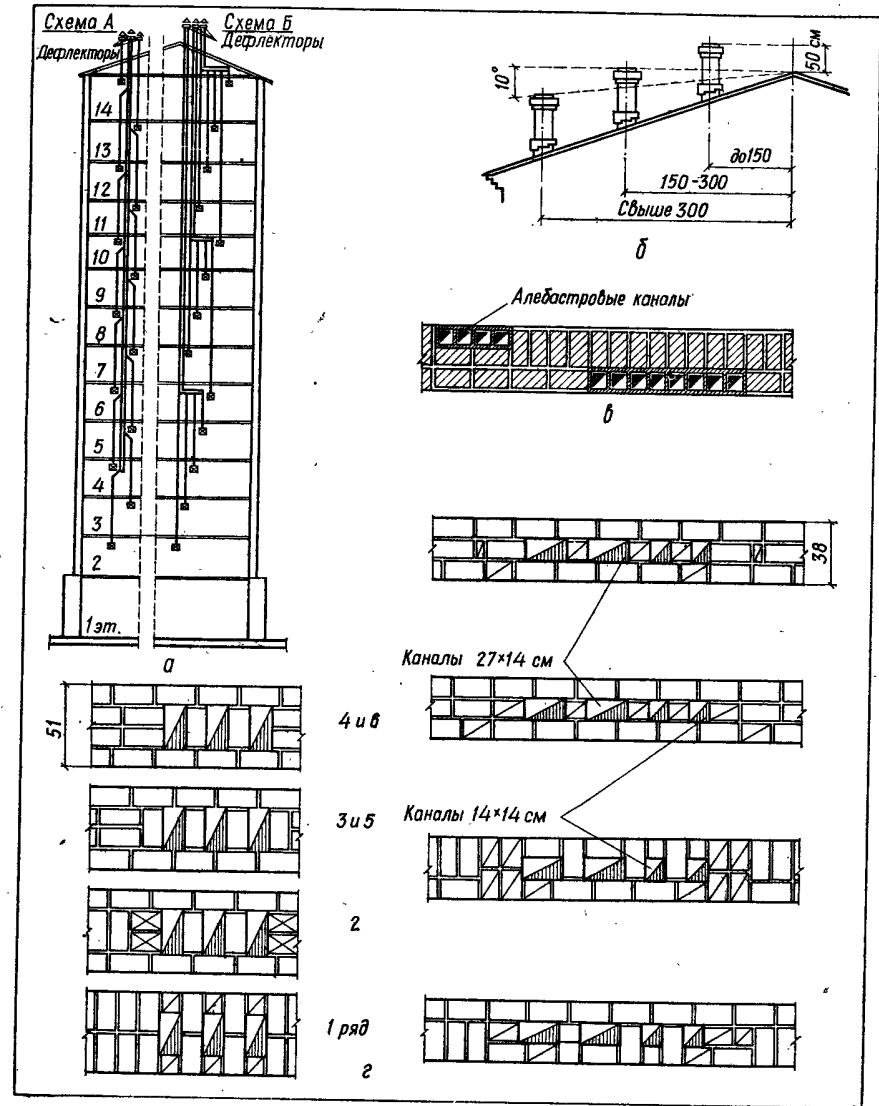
Принципиальные схемы устройства вентиляционных каналов:
